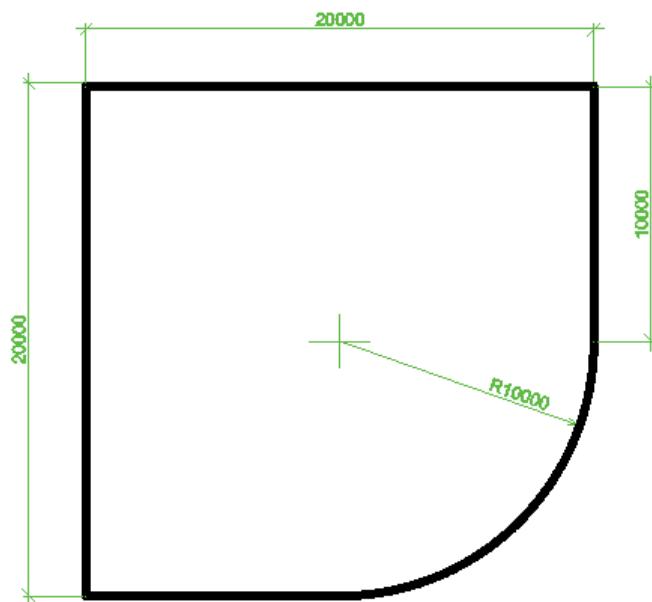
Круглое здание с тремя прямыми углами
